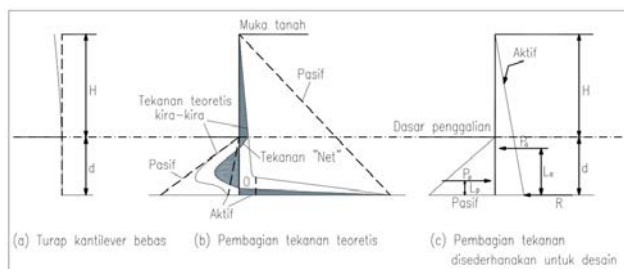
Stabilitas lokal dinding basement (retaining wall)
